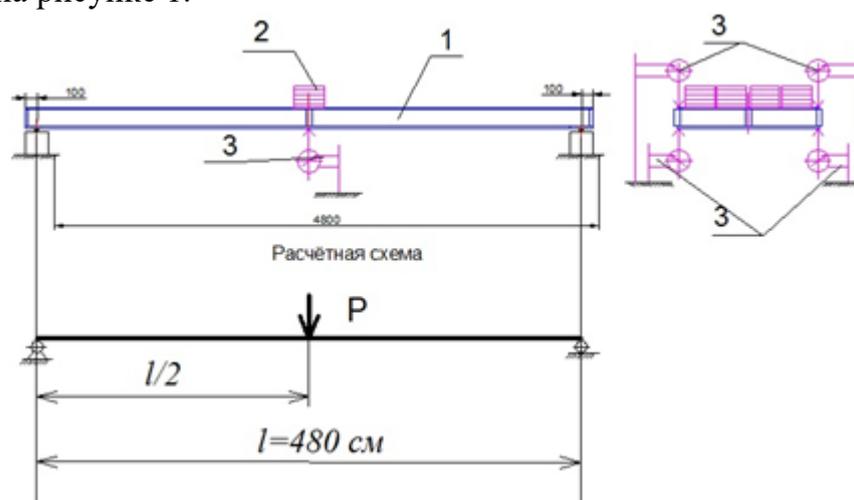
Схема нагружения и расчётная схема плиты перекрытия: 1- фрагмент перекрытия, 2 – грузы, 3 - прогибомеры
